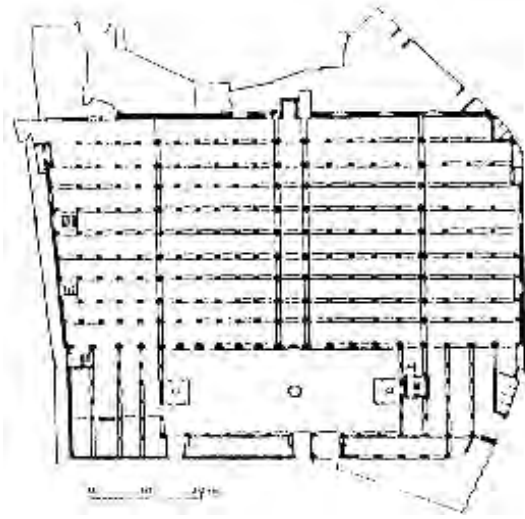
مسقط أفقي لجامع أبي العباس
